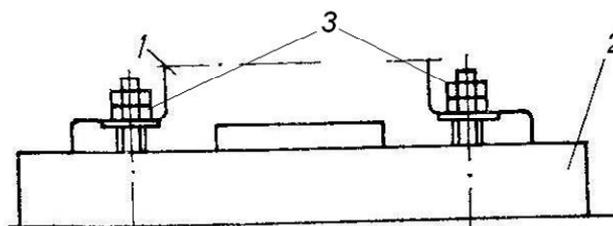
Схема установки оборудования на фундамент с опиранием непосредственно на фундамент:
